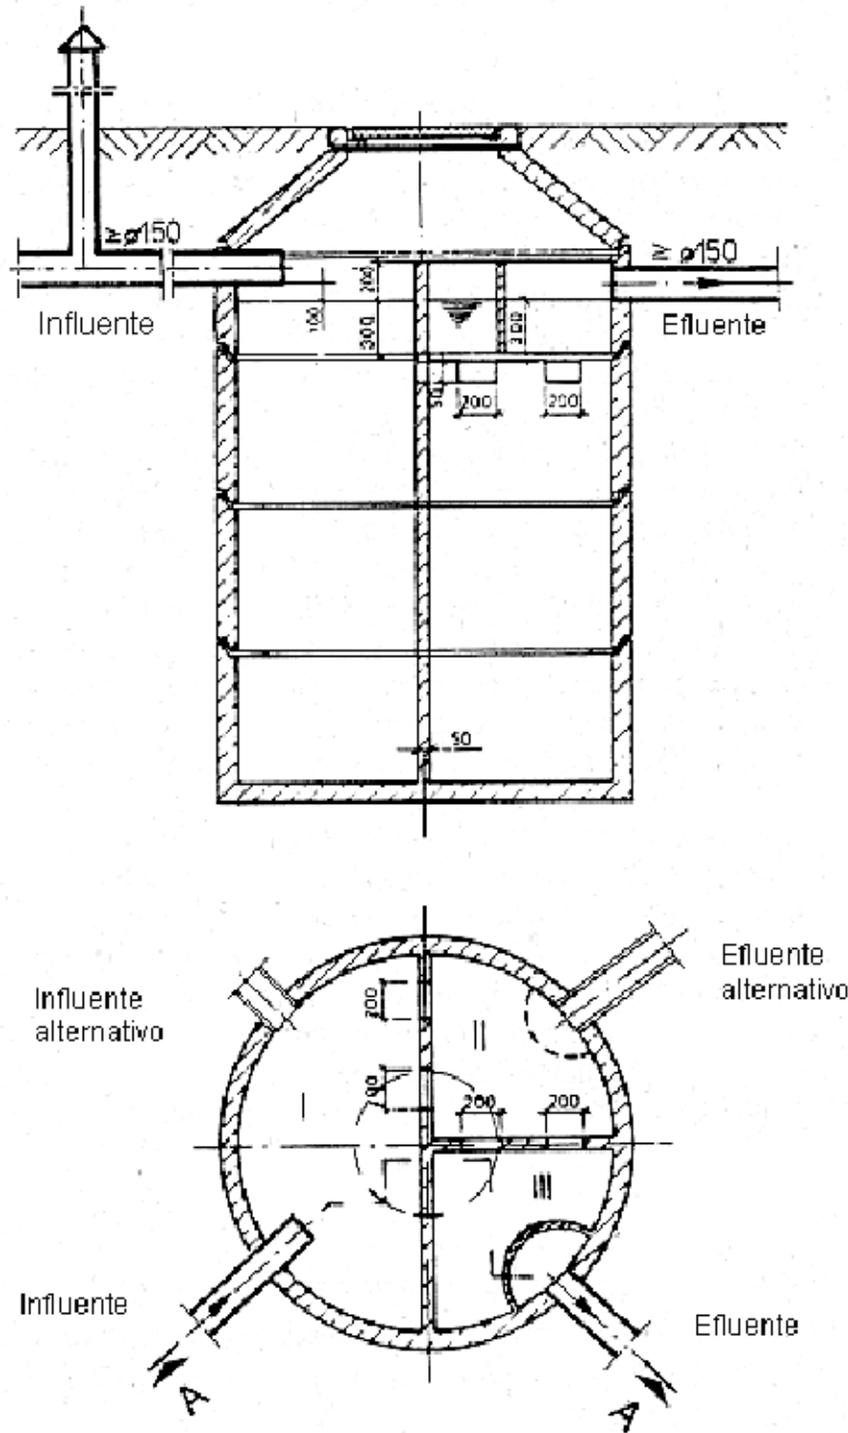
Esquema constructivo de un tanque de sedimentación en tres etapas (Fuente: DIN 4261, 2002; parte 1)
